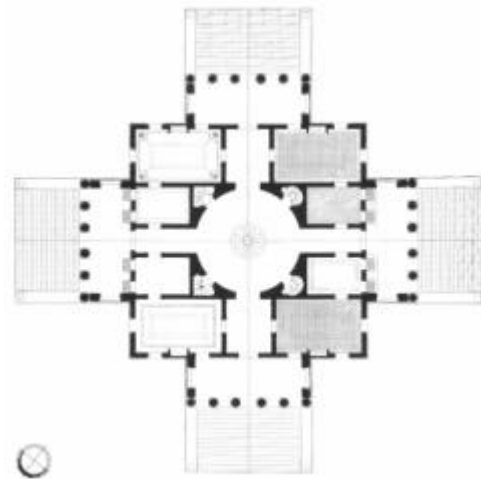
Andrea Palladio, Villa Rotonda, Vicenza, 1566-1567, Grundriß Piano Nobile (aus: Assunto 1990, wie Abb. 261, 65)
